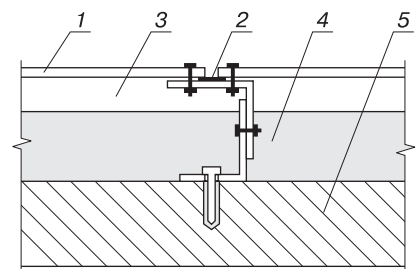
Схема крепления по металлической обрешетке: 1 — плита; 2 — резиновая лента; 3 — вентиляционный зазор; 4 — утеплитель; 5 — стена
